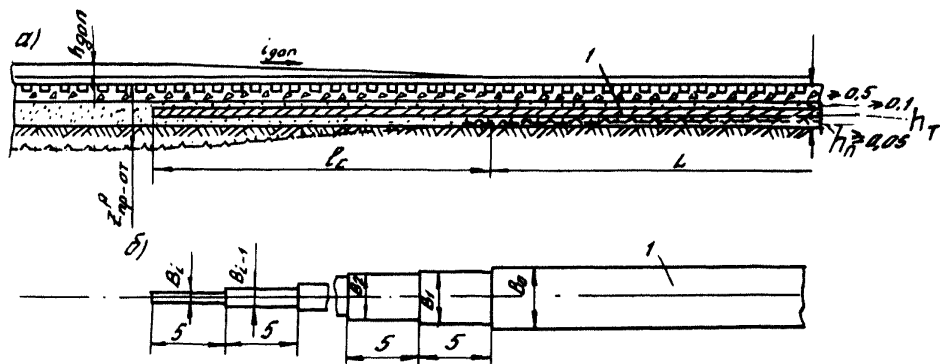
Схема размещения тепловой изоляции 1 на участке сопряжения:
